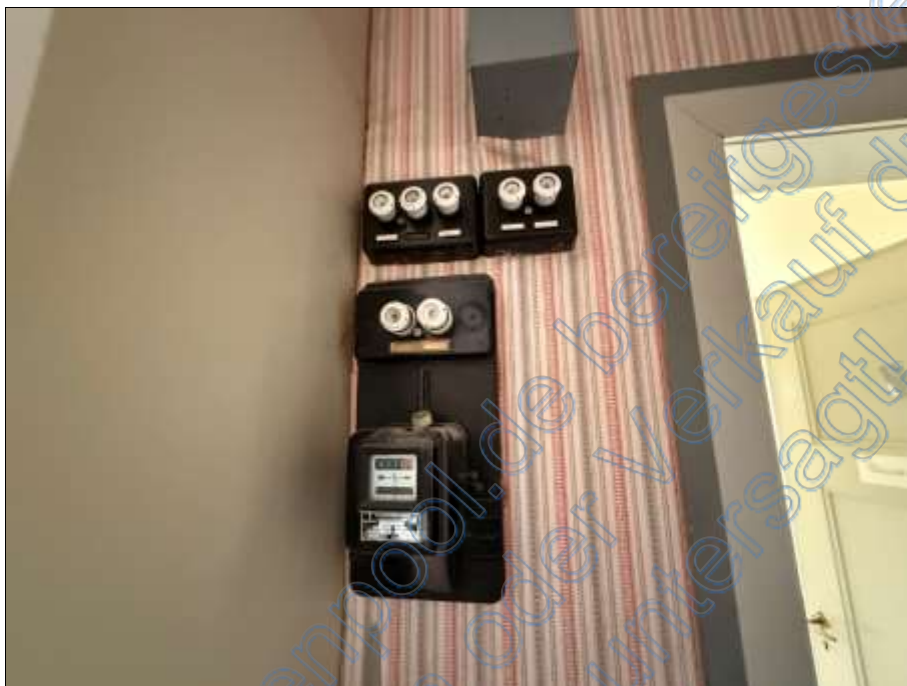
DG, Detail – Elektroinstallation, Sicherungen
